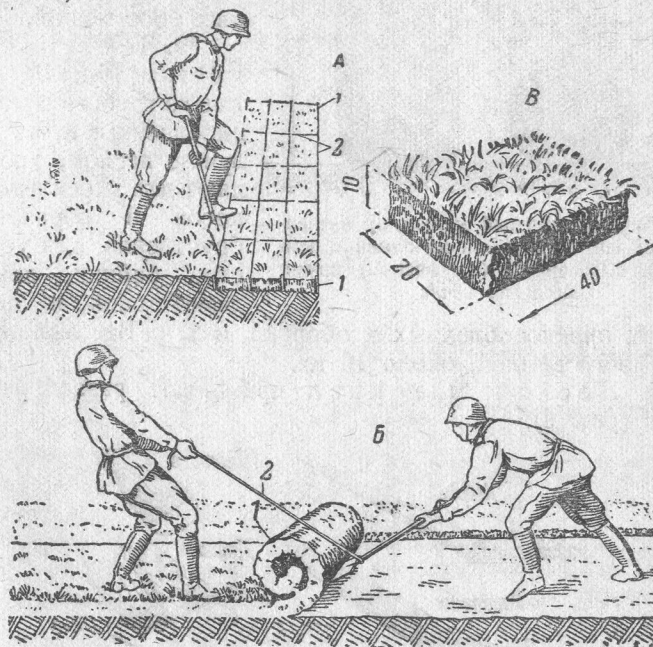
Дёрн и его заготовка дернинами и рулоном:
